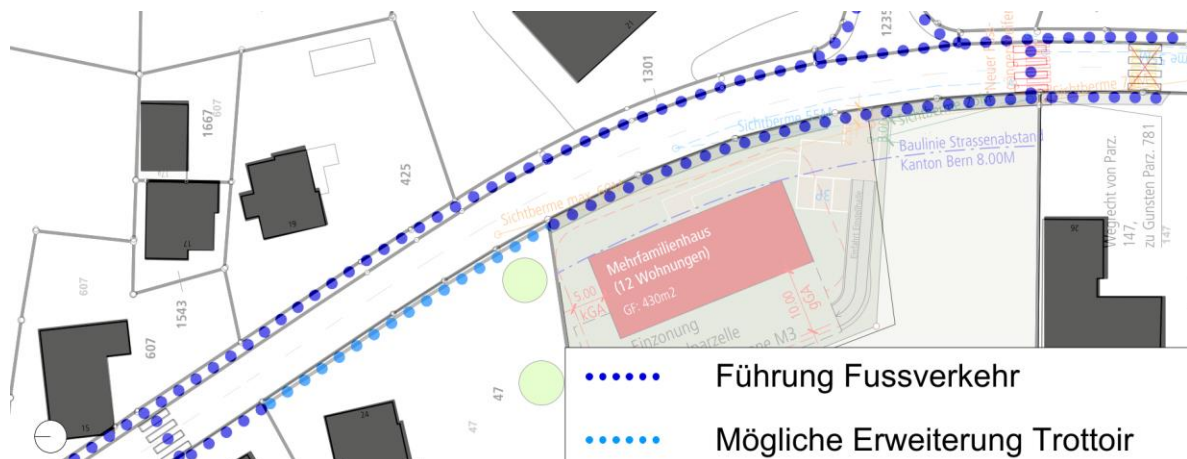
Erschliessung Fussverkehr; Grundlage Plan «Teileinzonung Parz. Nr. 781» HBR Architekten
